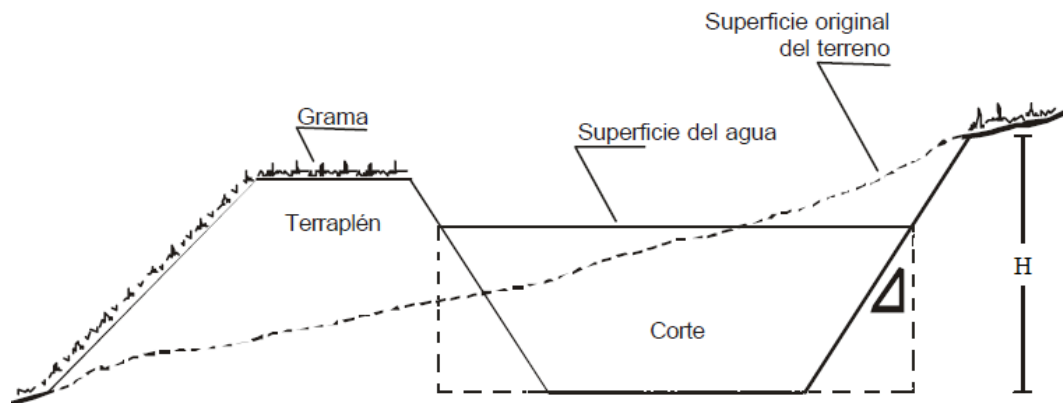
Detalle de la sección transversal del canal trapezoidal
